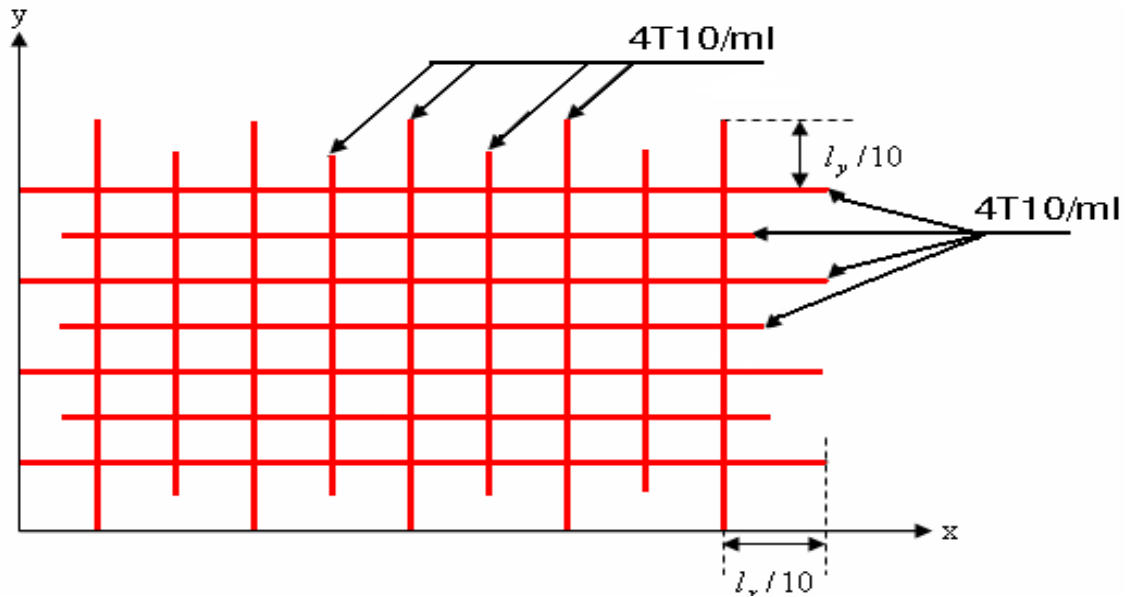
Schémas de ferrailage de la dalle de l'ascenseur.
